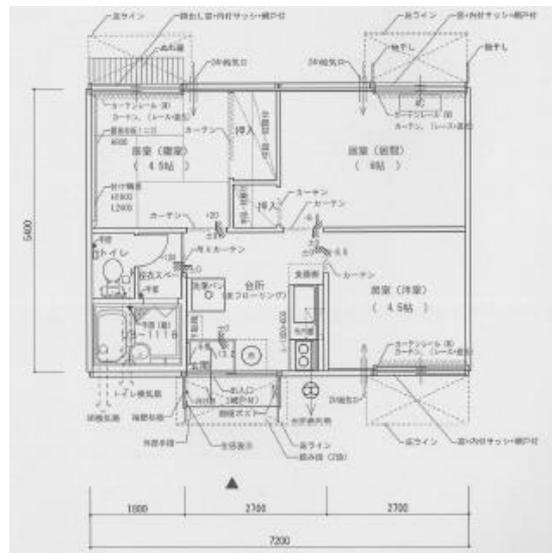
プレハブ 12 坪型平面図<sup>4)</sup>
